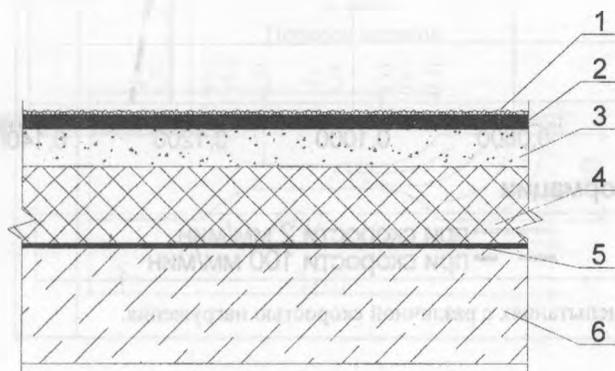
Совмещенная кровля с прямым размещением слоев:
